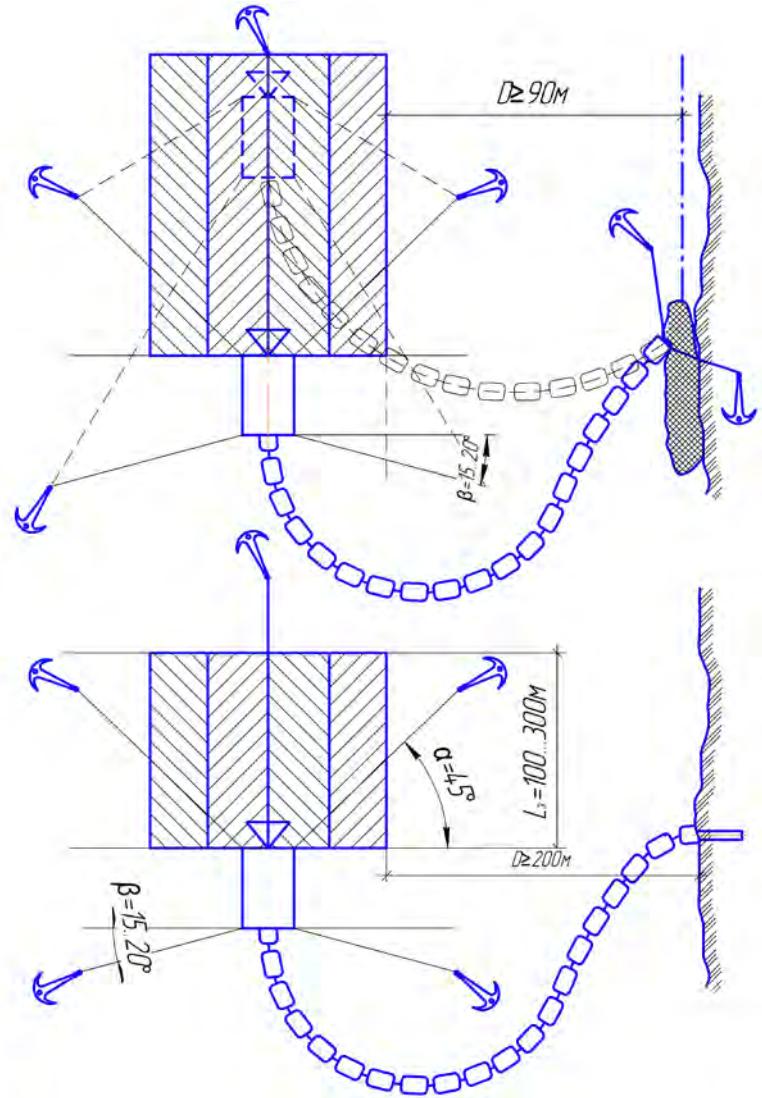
Схемы установки на участке работ траншейного землесоса с рефулированием грунта на подводный отвал (вверху) и на береговой отвал (внизу); D – удаленность отвала грунта от бровки; L_3 - длина проходки; α – угол опережения рабочего троса;
